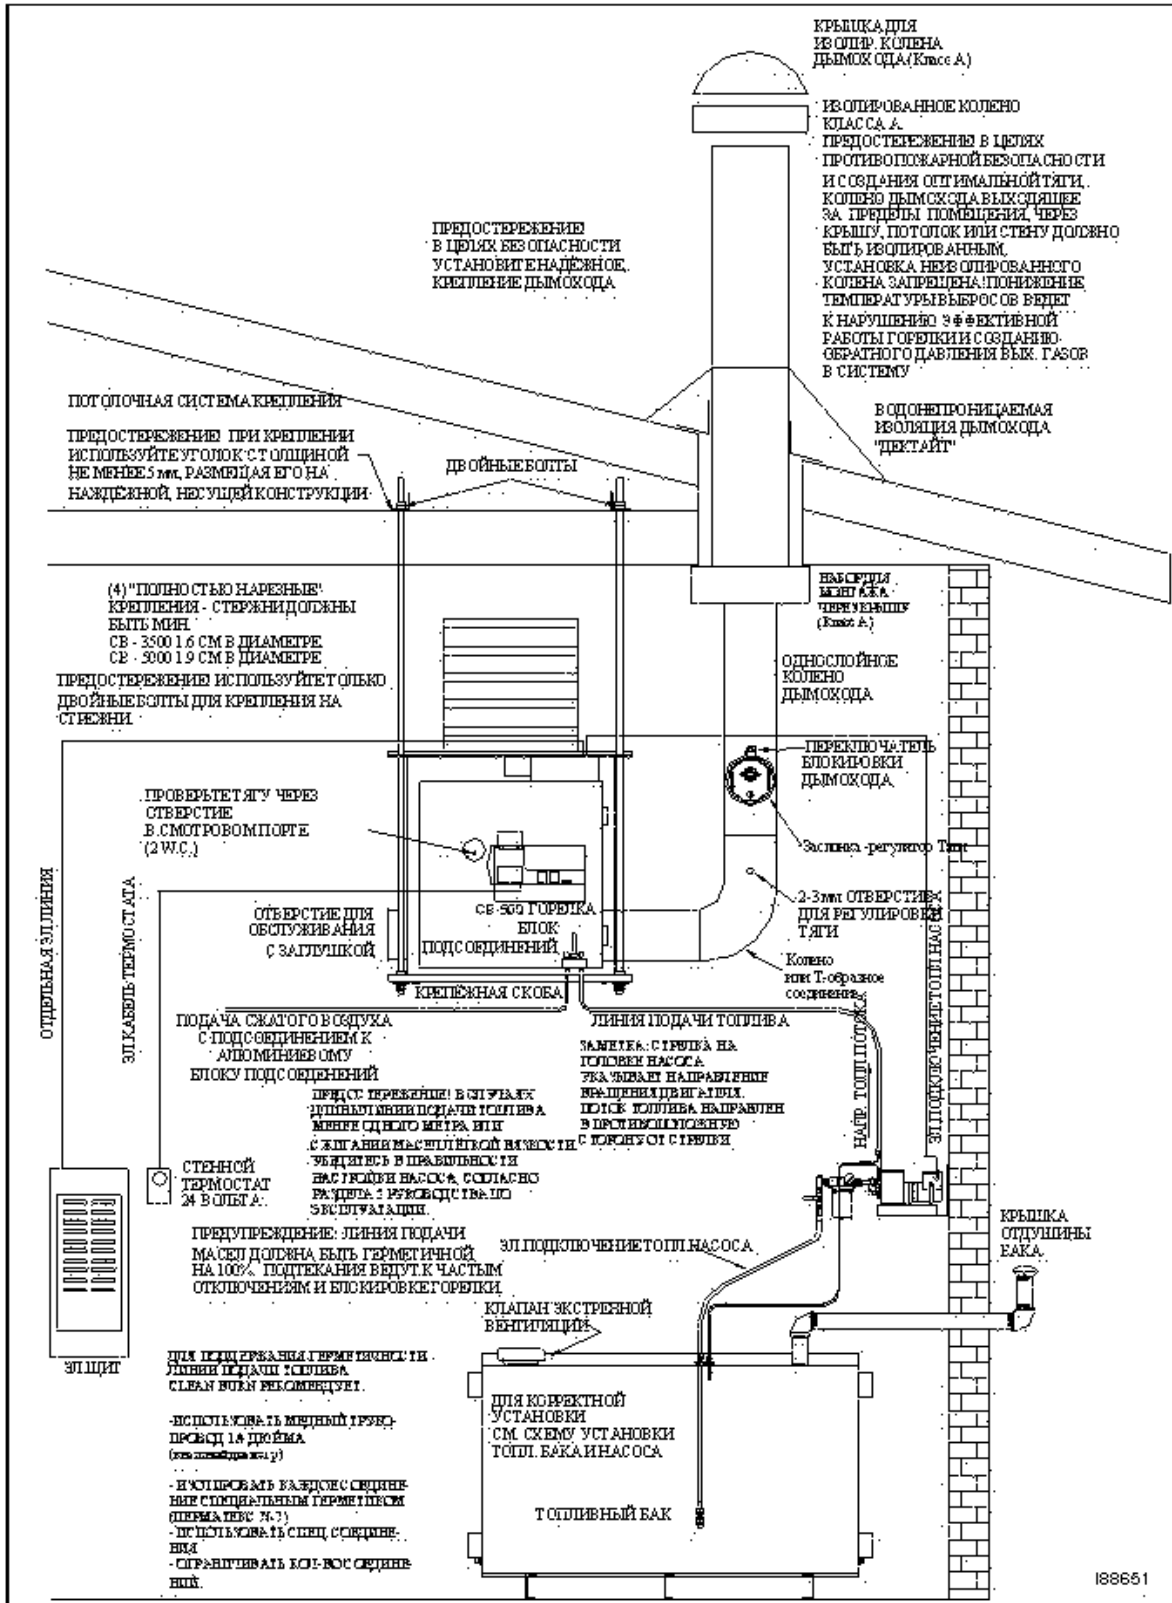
Стандартная схема установки Воздухонагревателей
